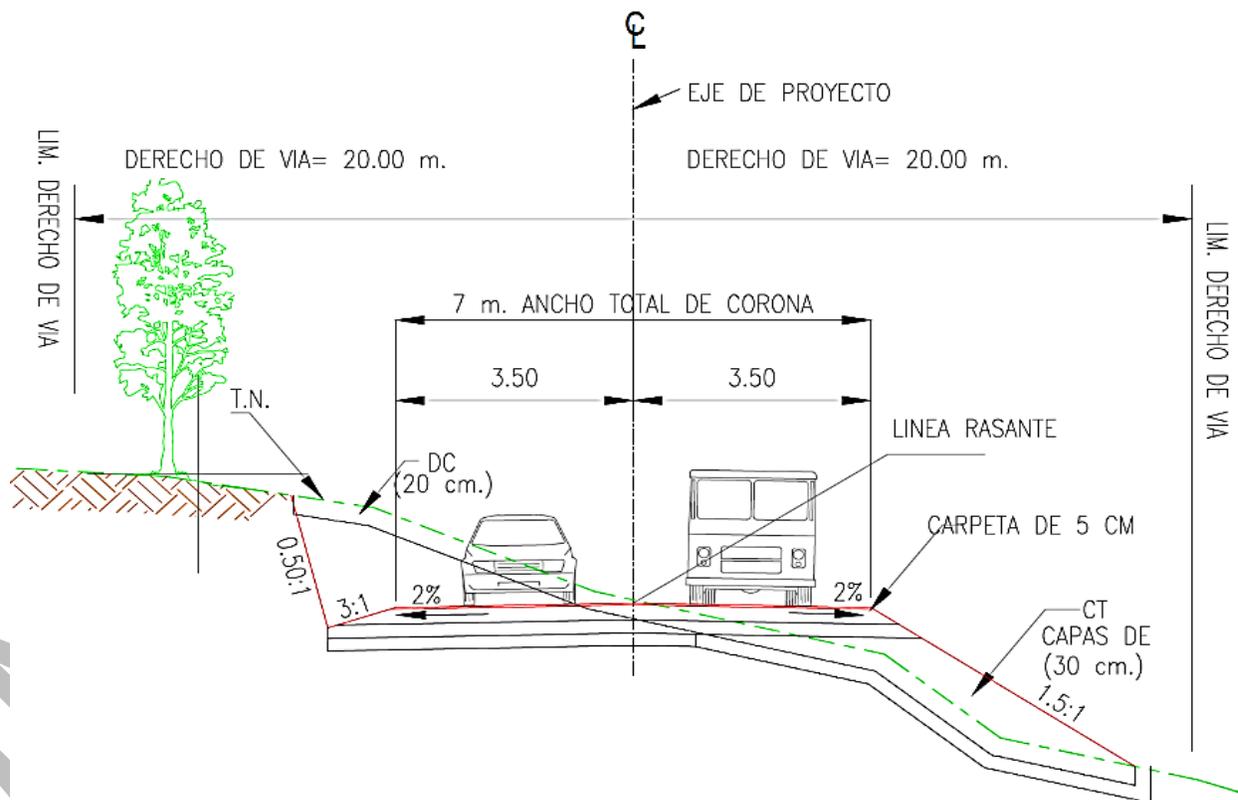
Sección tipo del proyecto de Construcción del camino.
